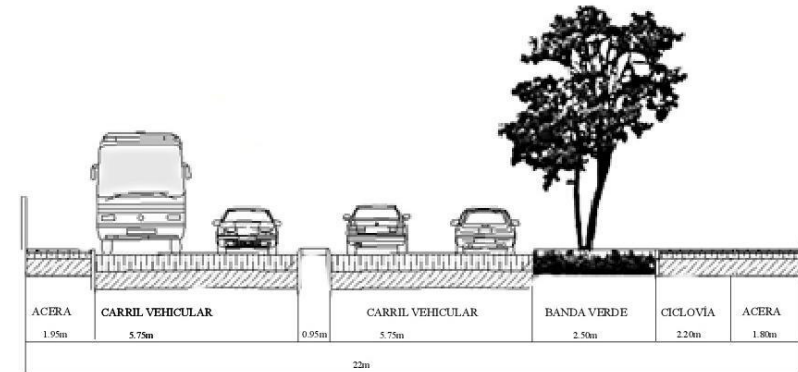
Estado actual tipo de la estructura vial en la Av. Ordóñez Lazo, etapa II
